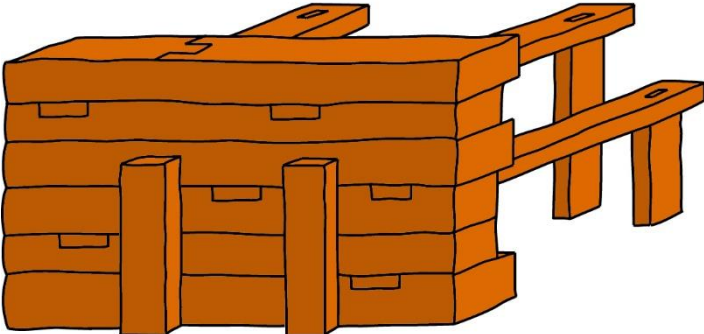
Constructie van een beschoeiing met horizontale planken.
